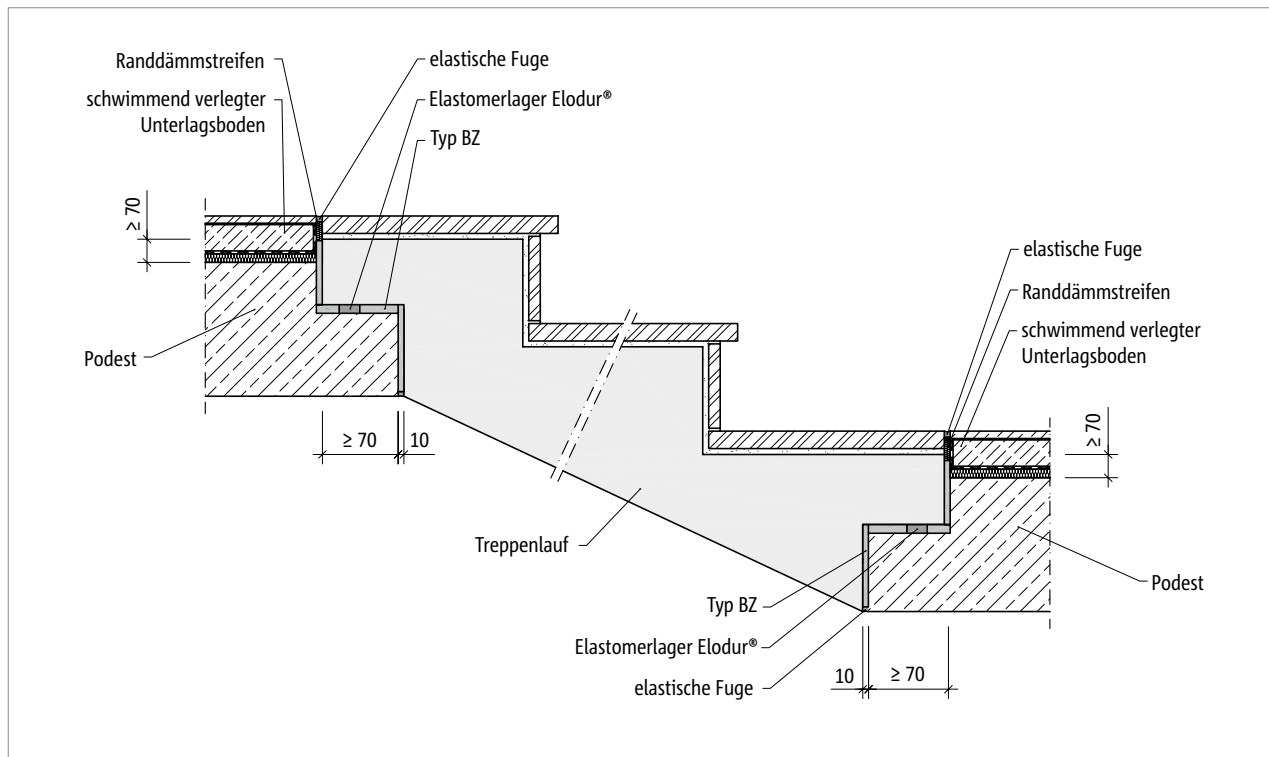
Schöck Tronsole® Typ BZ: Einbauschnitt
